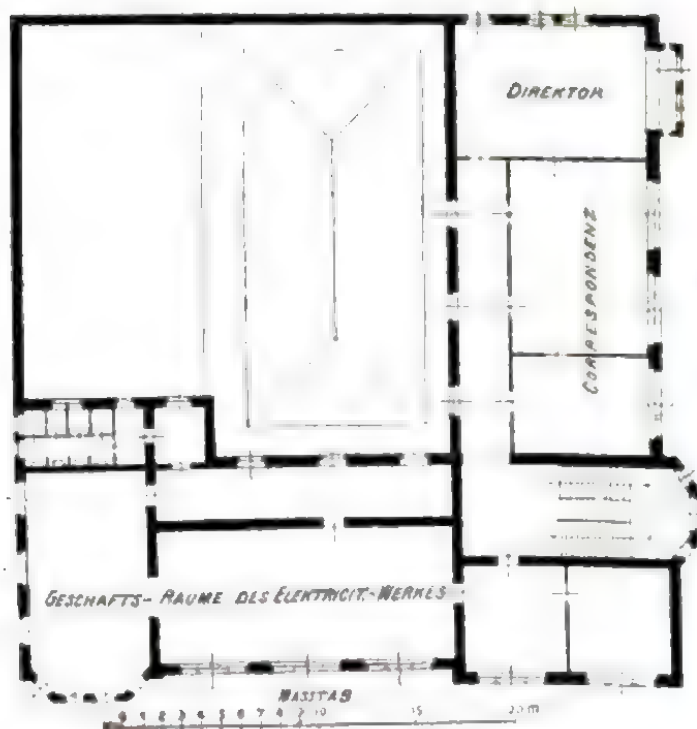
Grundriß zum 1. Obergeschoß des Direktionsgebäudes.
